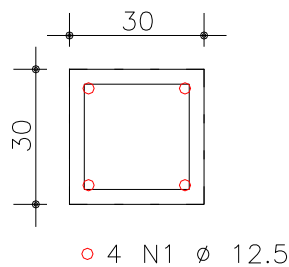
Detalhe típico da seção transversal com armadura de flexão dos pilares, lances 1 a 3
